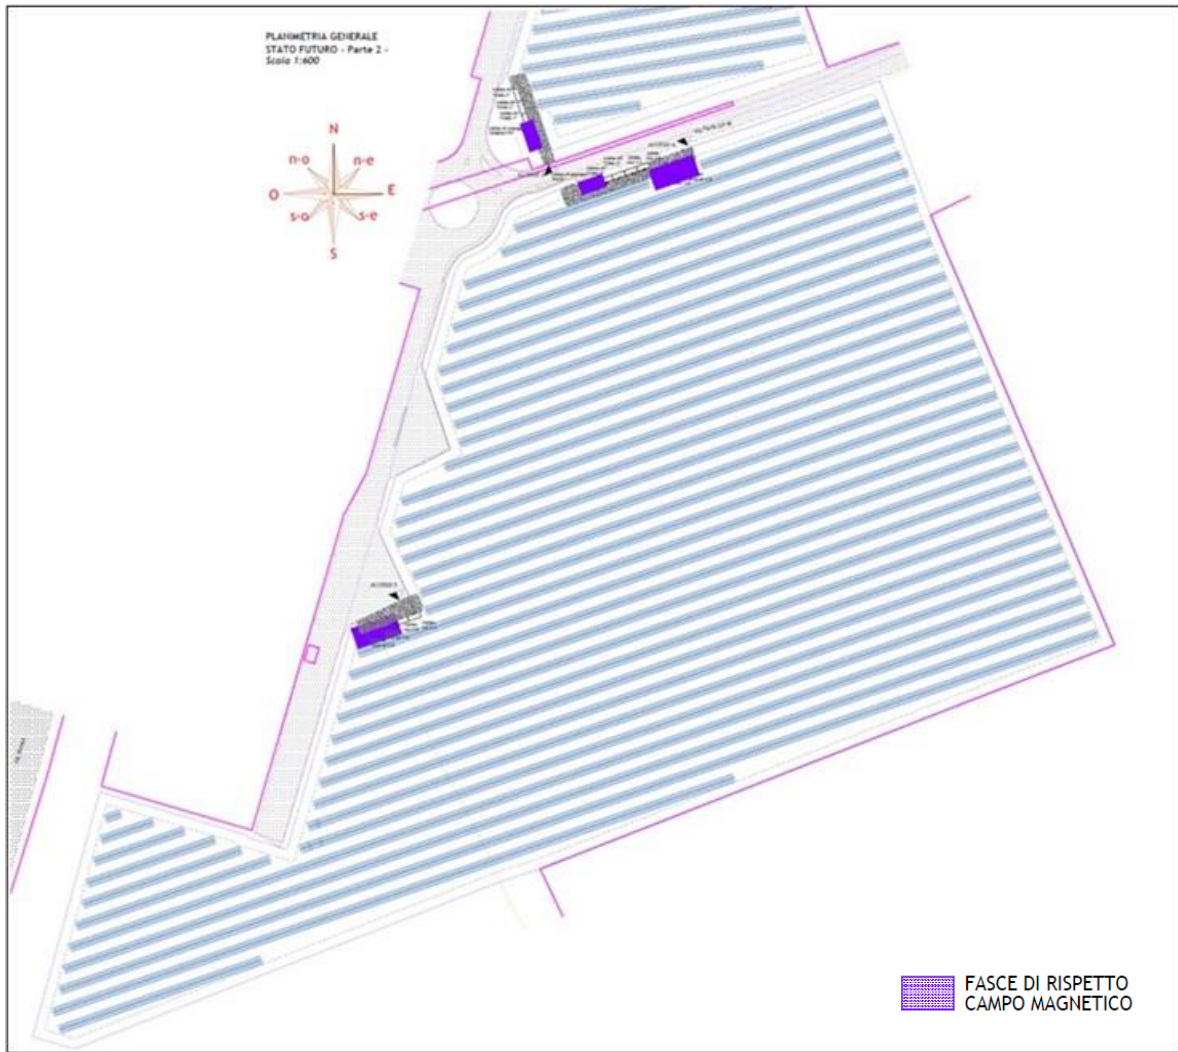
Planimetria individuazione fasce di rispetto determinate Area Sud
